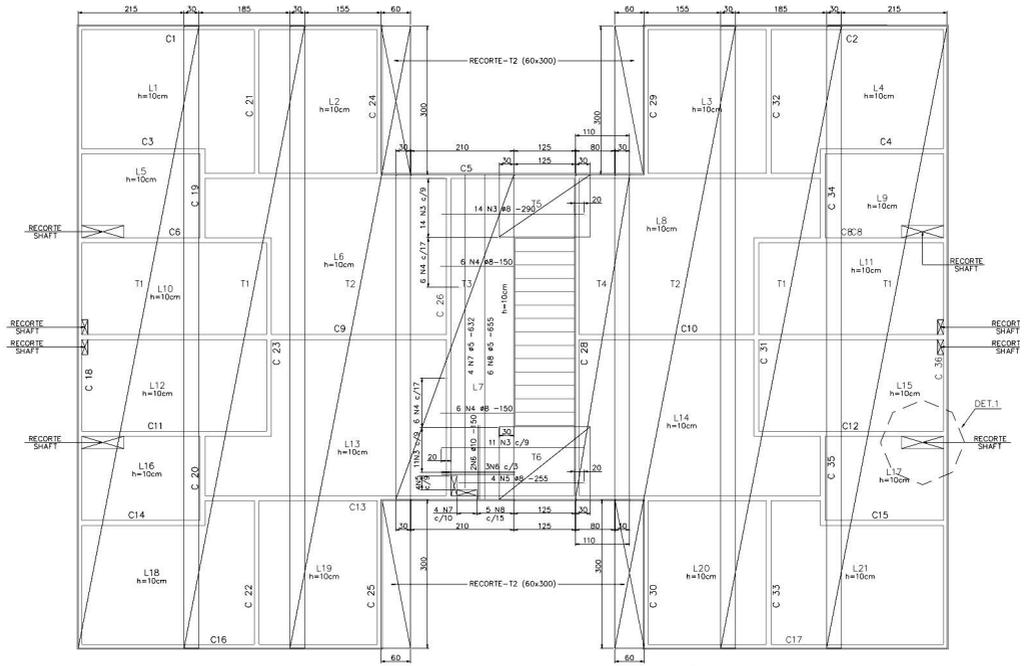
Planta armação inferior (positiva) de laje – pavimentos 1 a 4 (x4)
